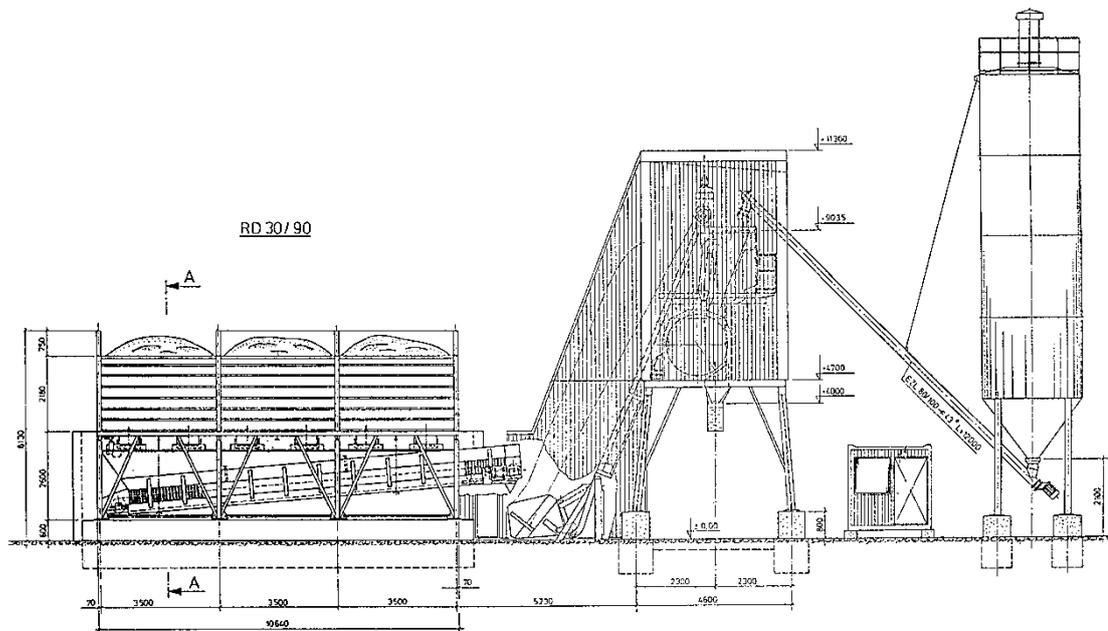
Baustellen-Horizontalsilo-Betonmischanlage ELBA Modul-Anlage EMA D 85/105/110 [7]
